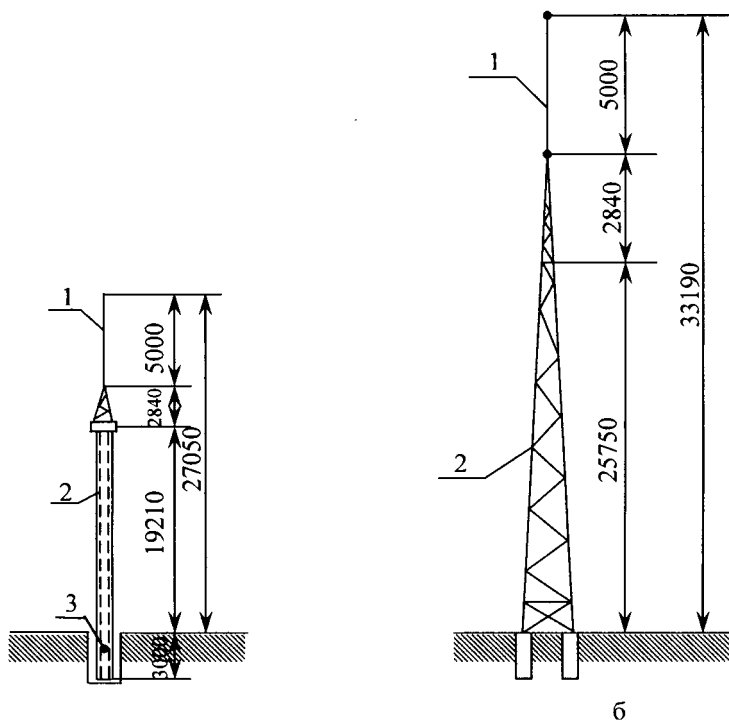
Конструкція стержневих блискавковідводів: а – на залізобетонній опорі; б – на металевій опорі.
